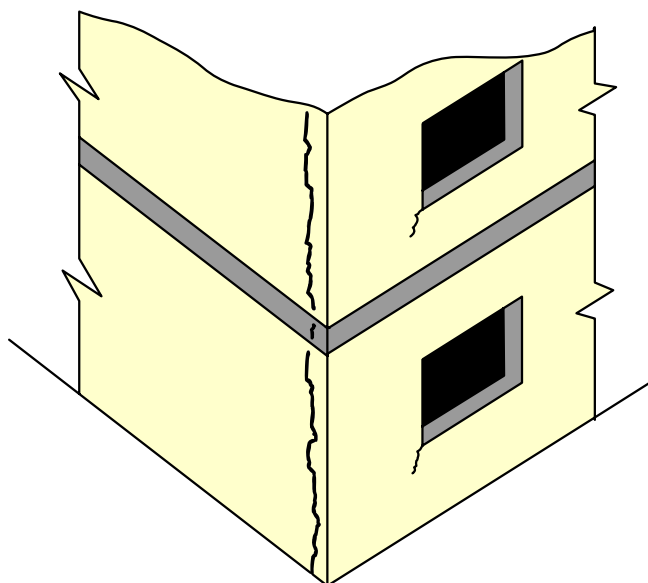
Expansão dos tijolos por absorção de umidade provoca o fissuramento vertical da alvenaria – Adaptada de THOMAZ, 1996
